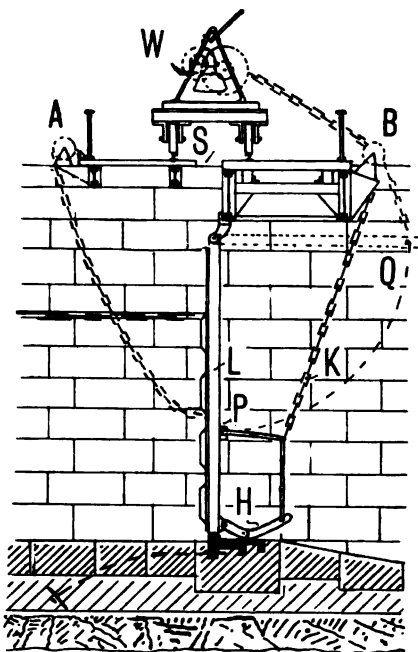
Querschnitt durch ein Wehr nach Pretziener Art.
